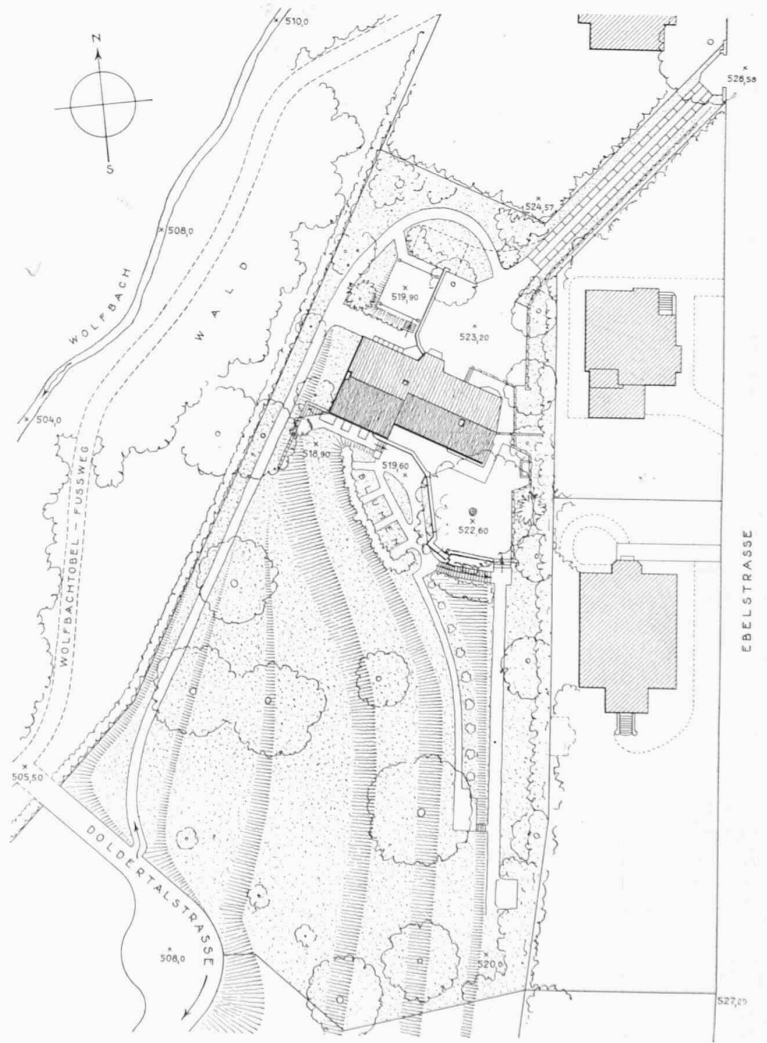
Lageplan des Hauses von Arch. M. Haefeli. — Masstab 1:800.
